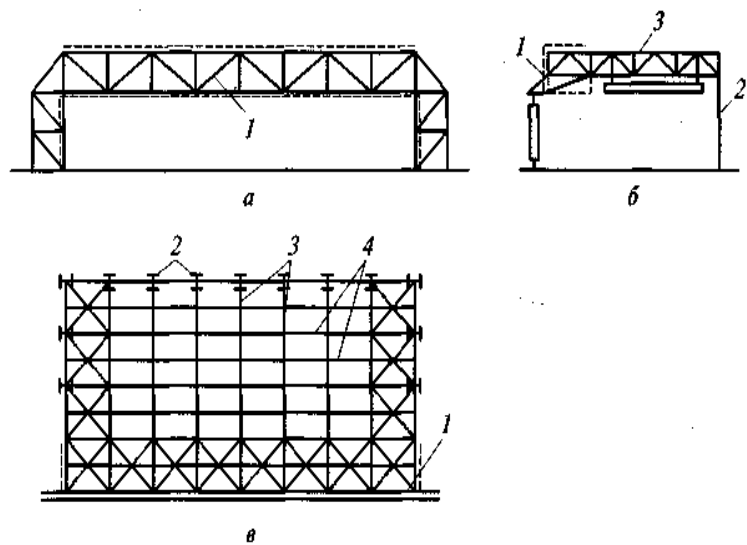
Продольна компоновка каркаса ангара а—фасад; б—поперечний перетин; в—план по верхньому поясу; 1—поперечна надворотня рама; 2—стойка фахверка; 3—прокольні ферми; 4—прогони
